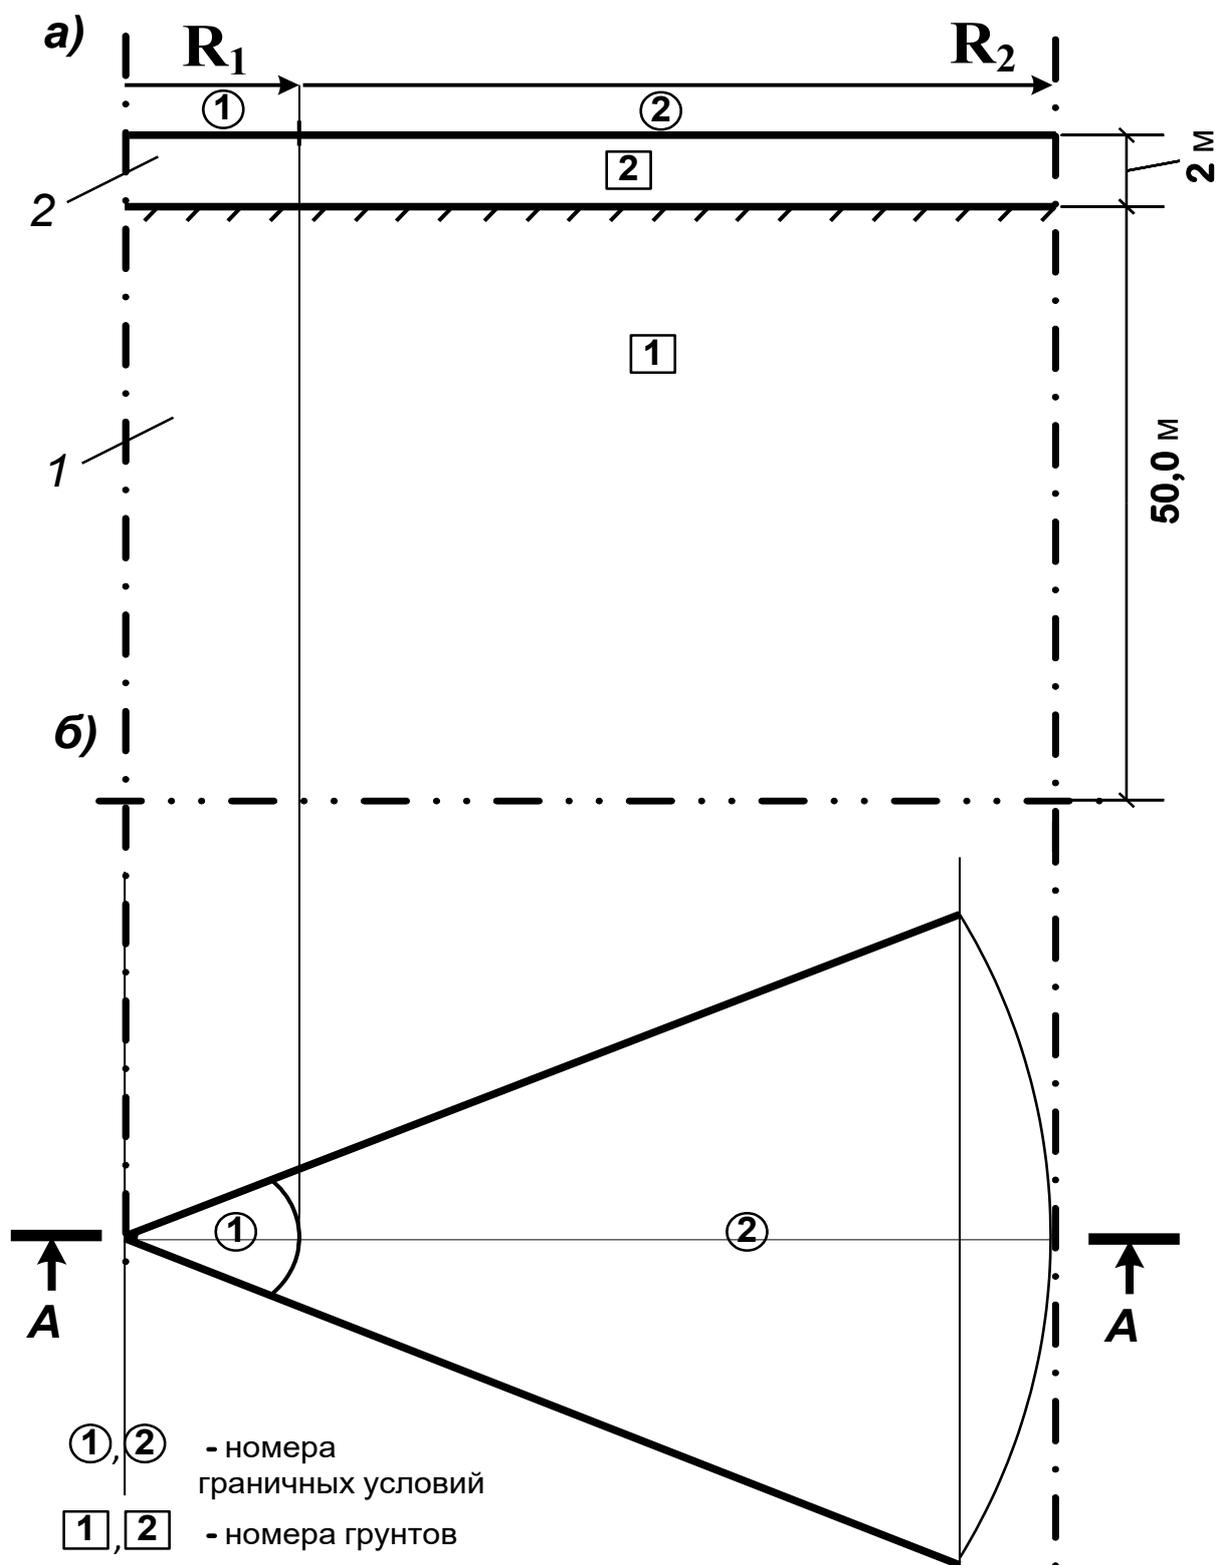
Расчётная схема для определения теплового влияния малого инженерного сооружения на грунты площадки и её основания: а – сечение А-А, б – план, 1 – грунт основания, 2 – площадка, R_1 – зона малого инженерного сооружения площадки.
